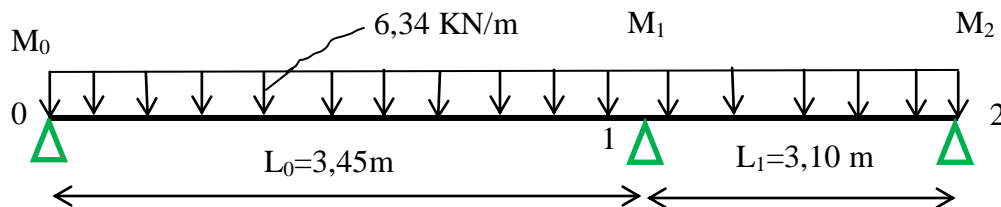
Schémas statique de la poutrelle de type02 (ELU).
